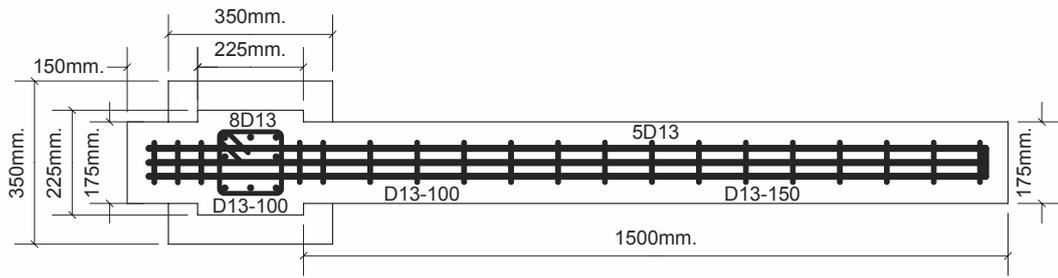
Dimensi Struktur Kantilever Balok Beton Bertulang
